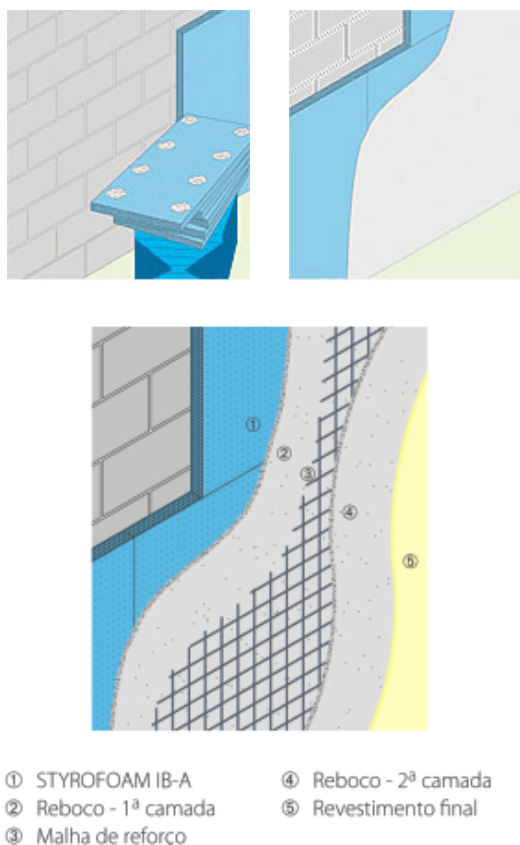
Isolamento pelo interior com o isolamento colado à face interior da parede exterior – modo de aplicação [27]
